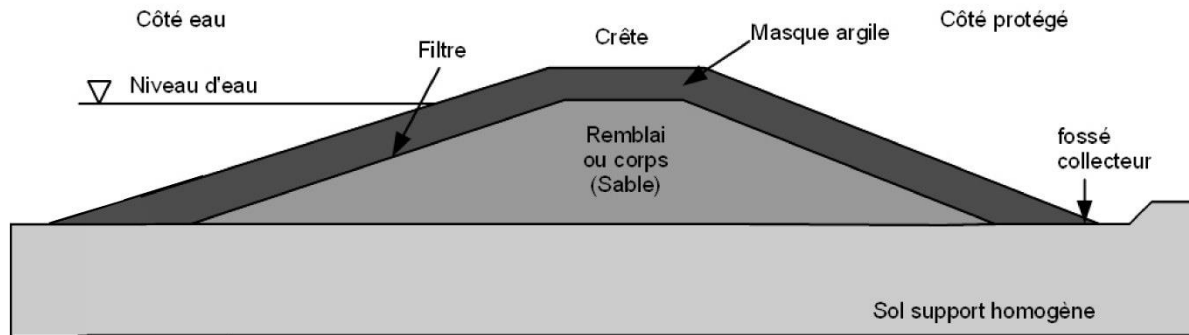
Digue zonée à masque étanche sur fondation homogène ; à noter la nécessité d'une protection contre la dessiccation du masque en argile
